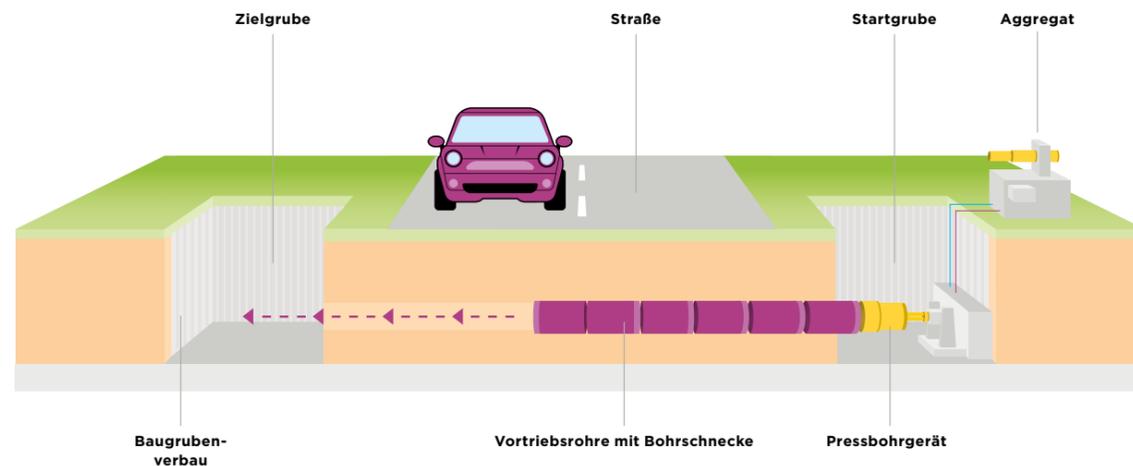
Erdkabel in geschlossener Bauweise (Rohrvortriebsverfahren) schematische Darstellung
